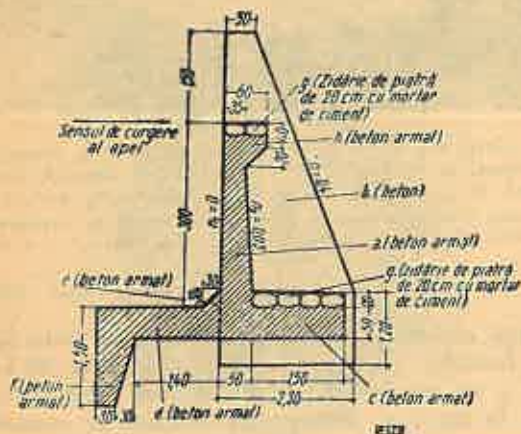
Secțiune transversală prin barajul din plăci de beton armat în consolă, executat în perimetrul de ameliorare Lerești-Muscel:
